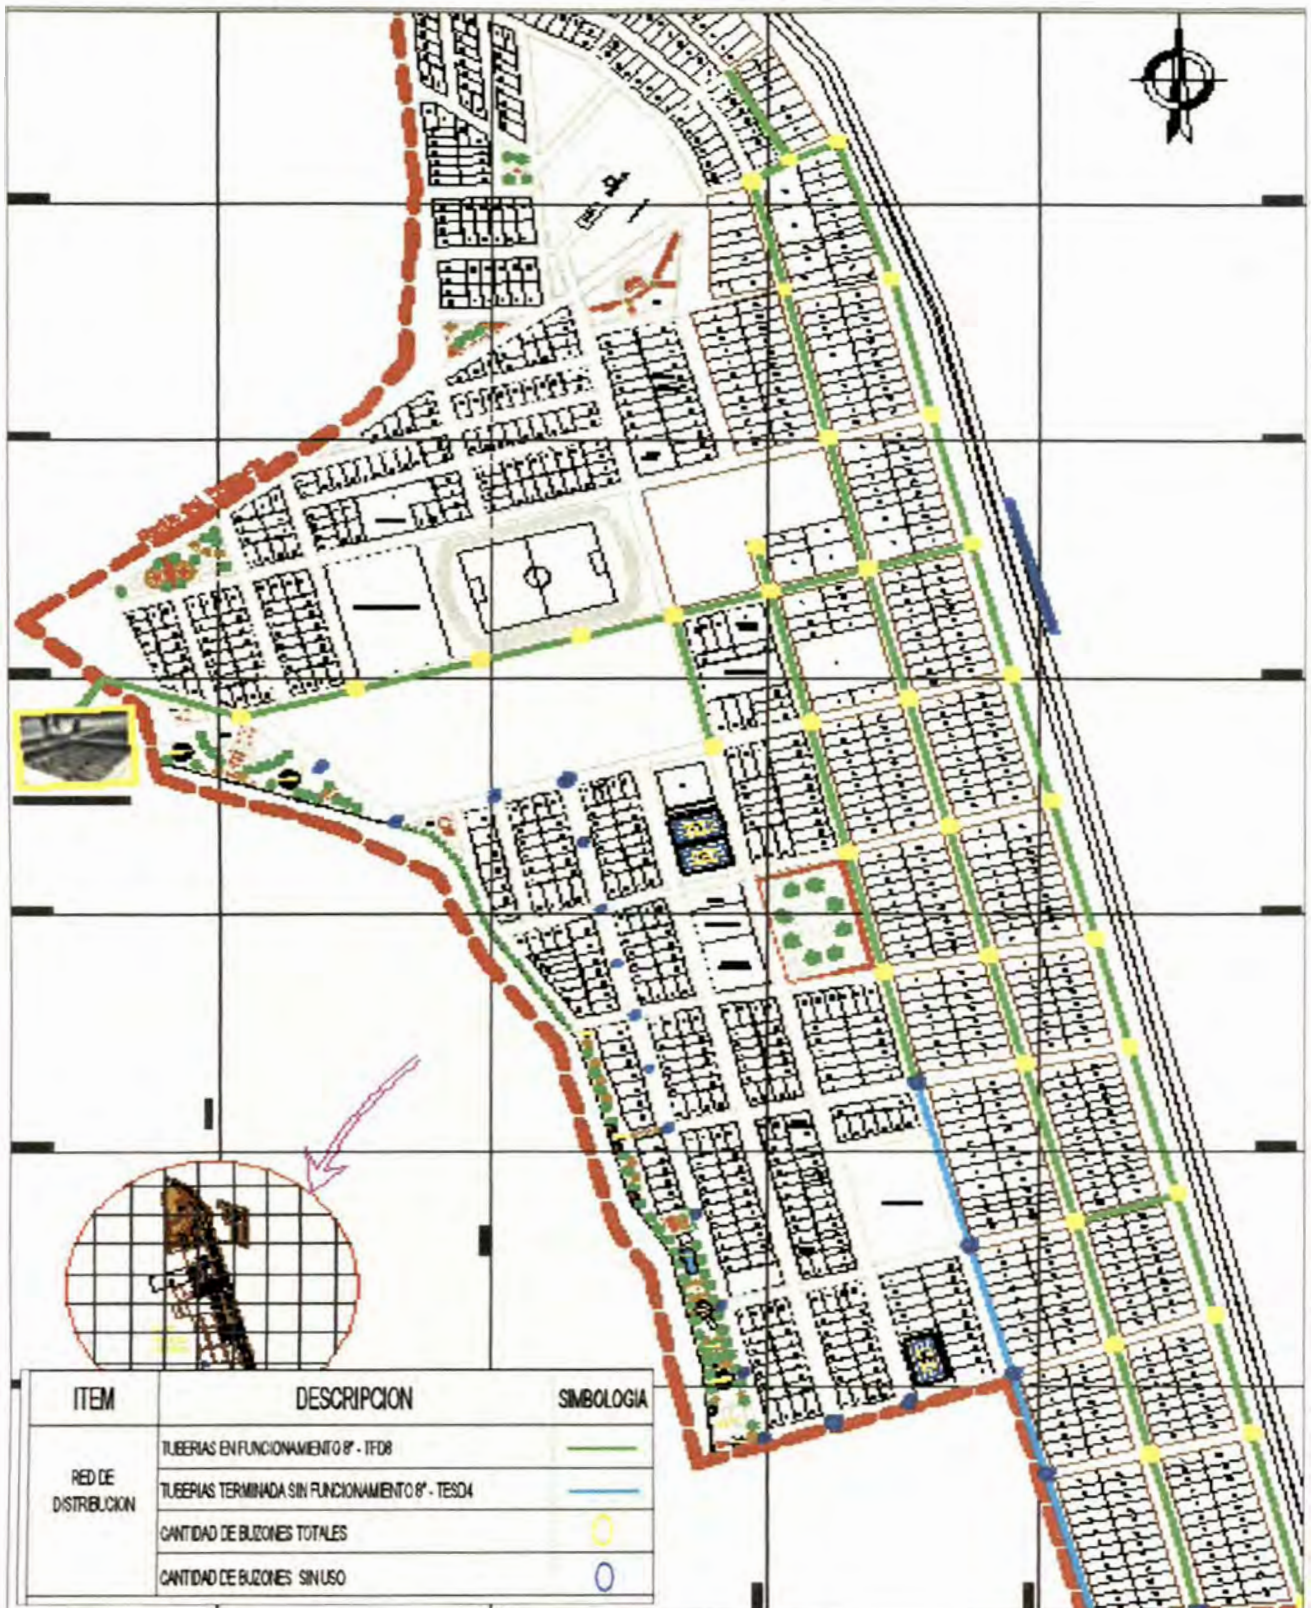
Trazo de la Red de Alcantarillado Existente
